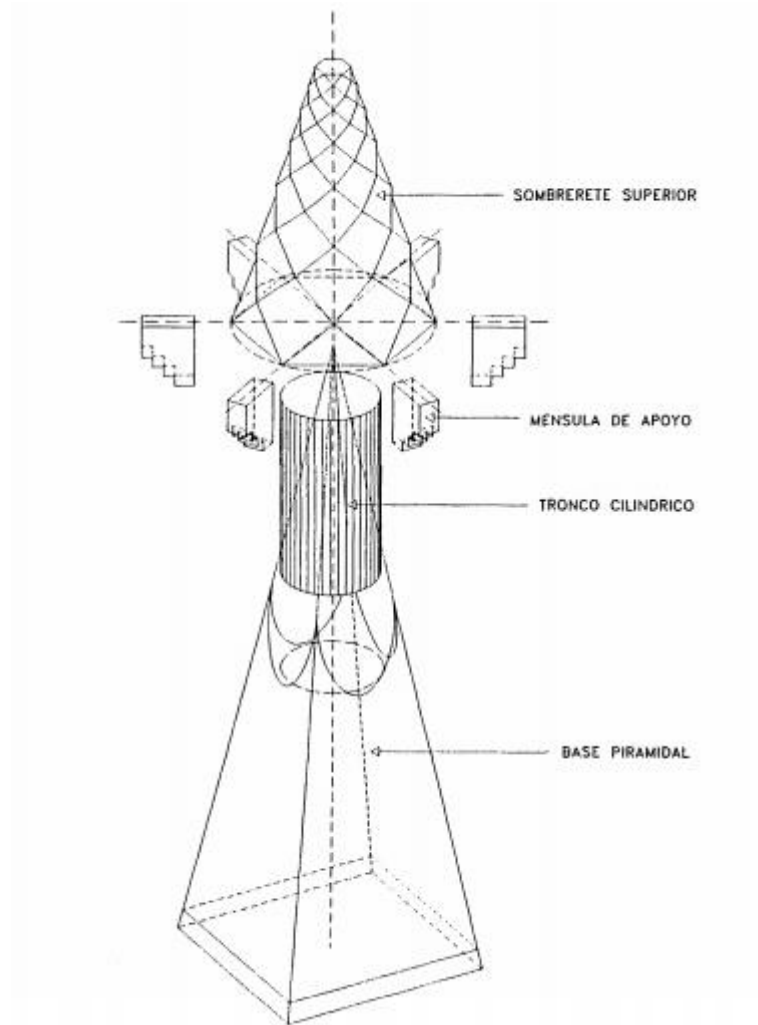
Despiece de las partes de la chimenea de la azotea del Palau Güell, Barcelona
